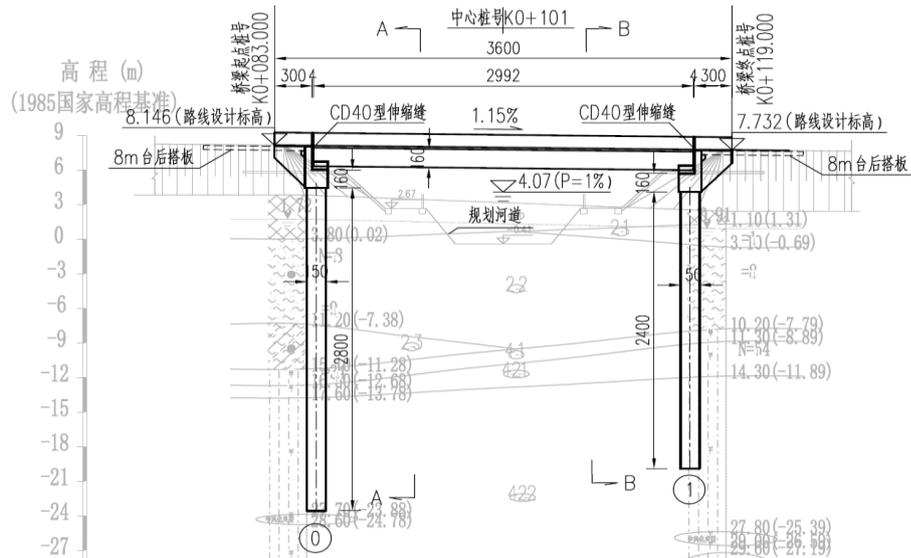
旺官路 1 号中桥桥梁桥型布置图
